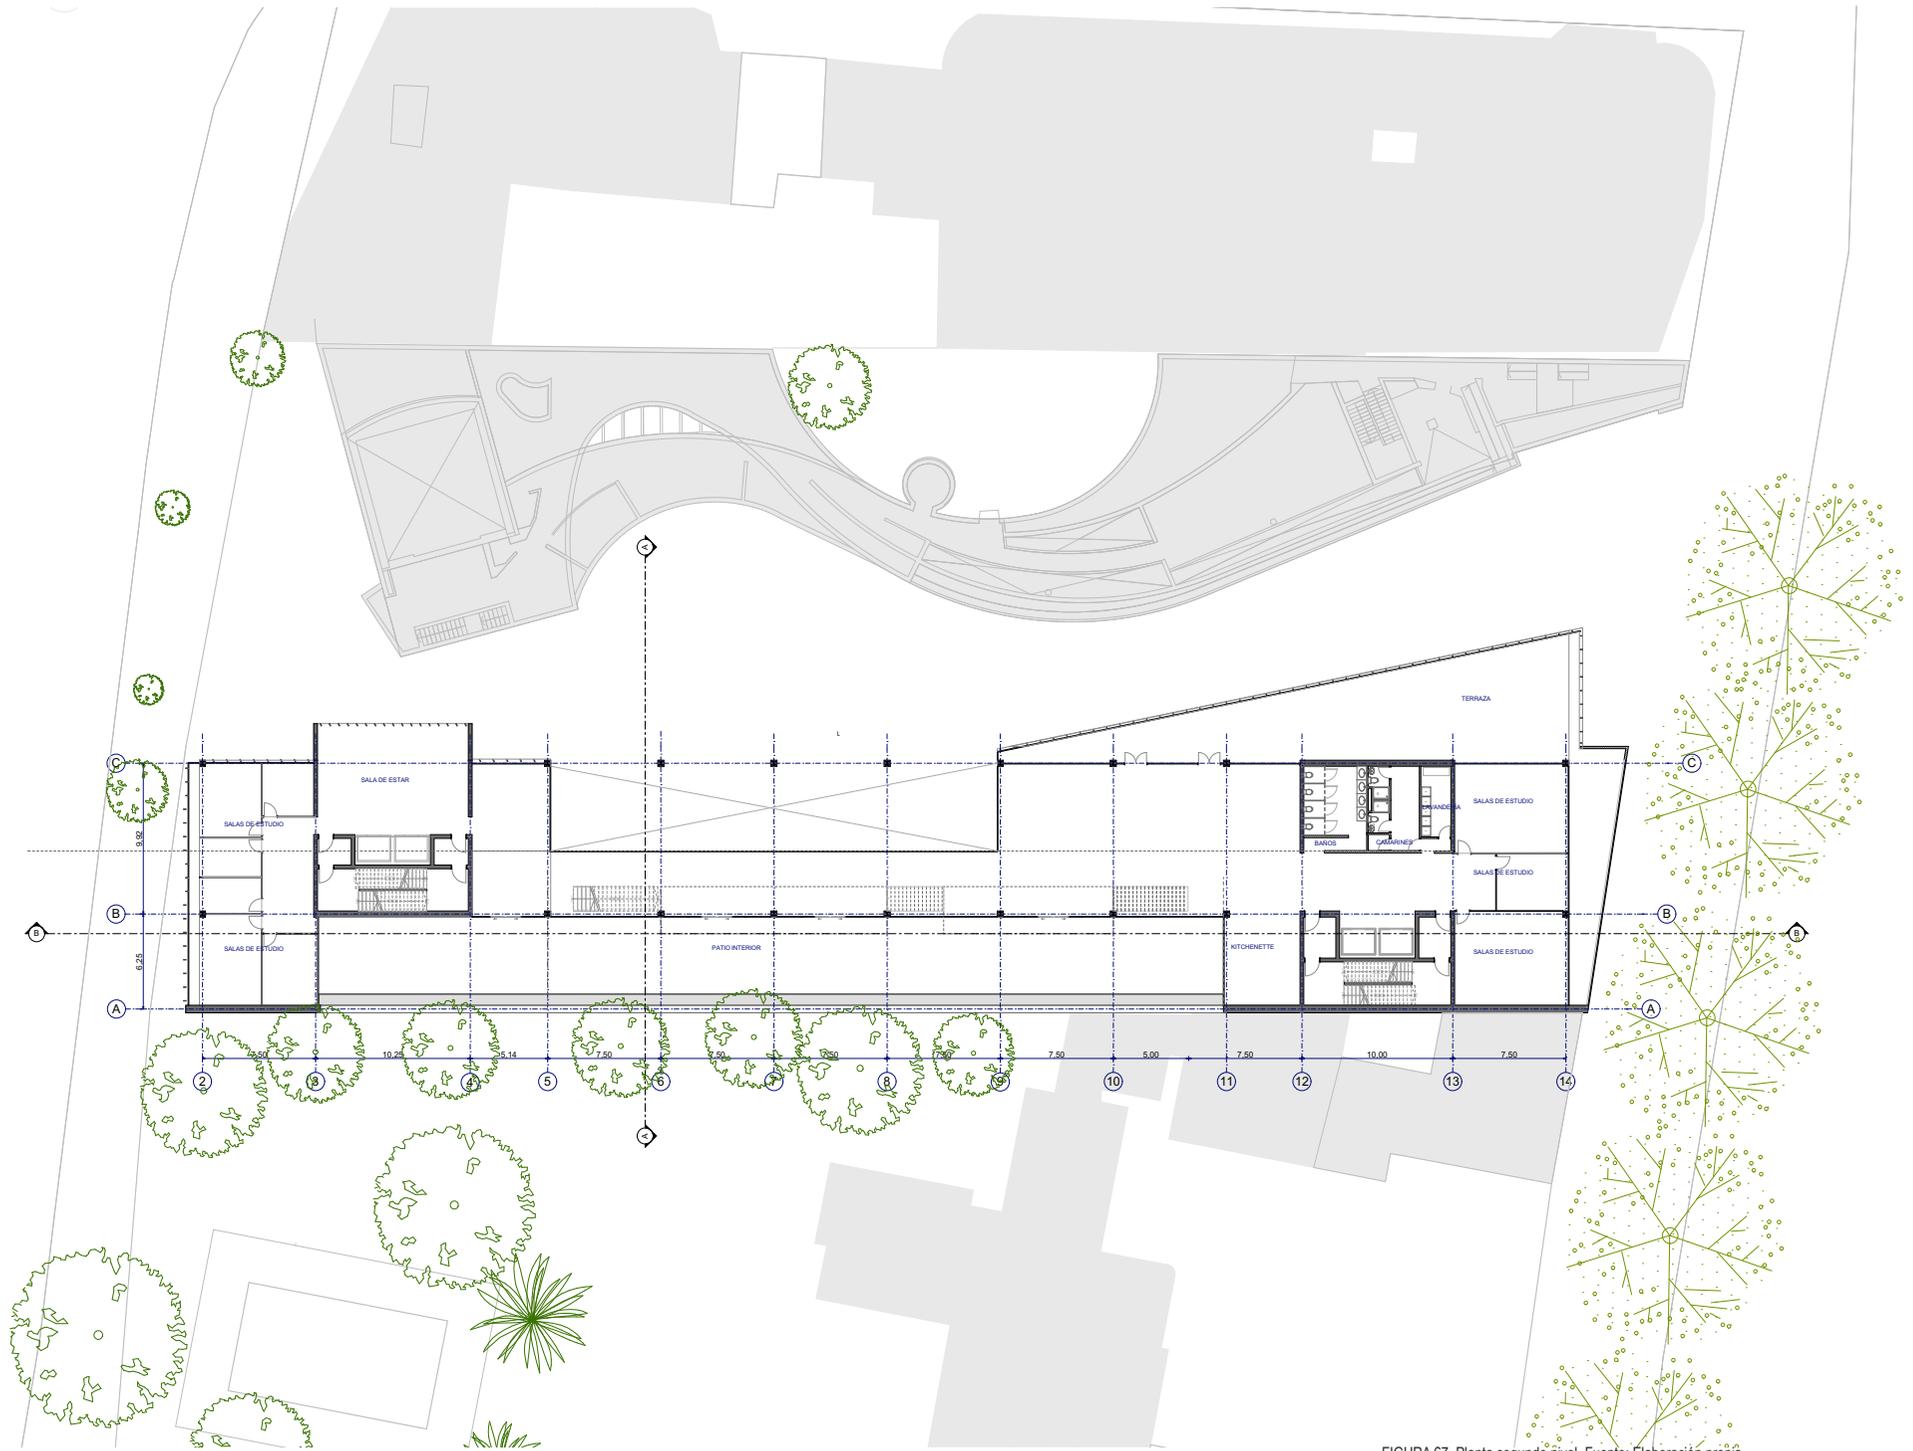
Planta segundo nivel. Fuente: Elaboración propia
